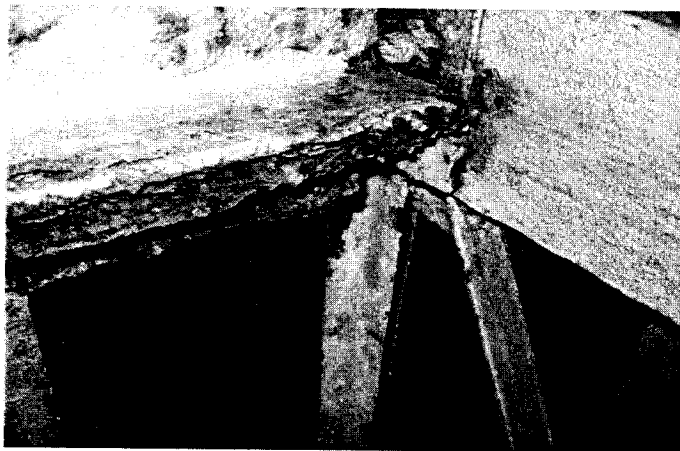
Низька якість зварних швів. Корозія металу елементів і зварних швів
